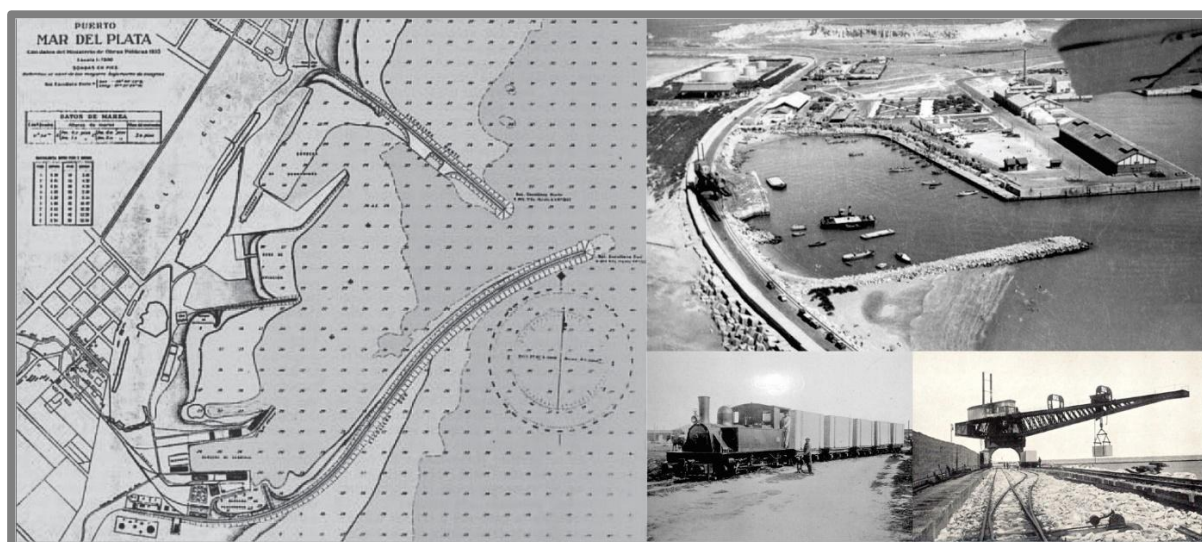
A la izquierda, plano del puerto publicado en la Carta Náutica de 1935, se observa el primitivo asentamiento urbano aledaño. A la derecha, foto aérea de la década de 1930 e imágenes de las obras de construcción: tren cargado de bloques de piedras y grúa Titán en la escollera Norte. (Fuentes: Fundación Histarmar
